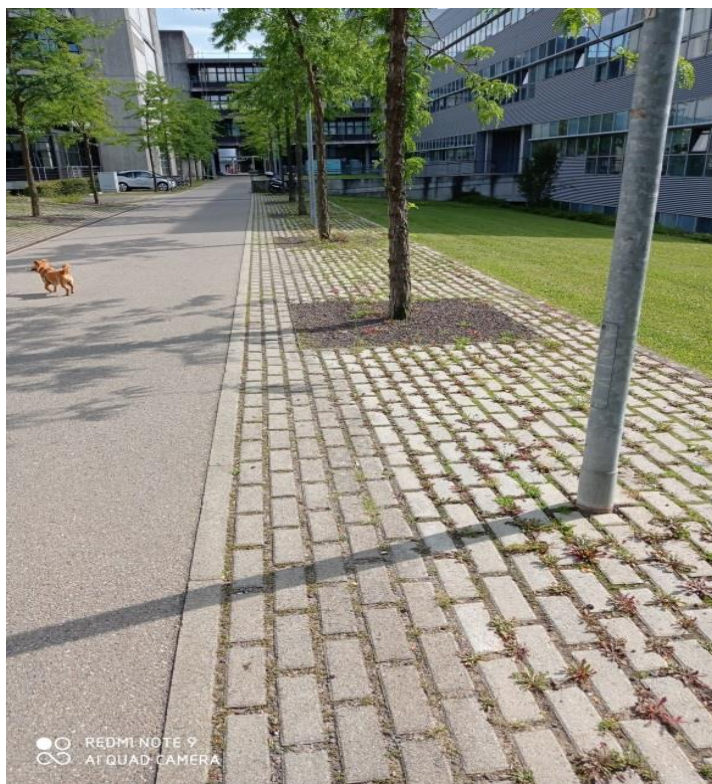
Pfaffenwaldring, Stuttgart.. Fonte: Própria.
